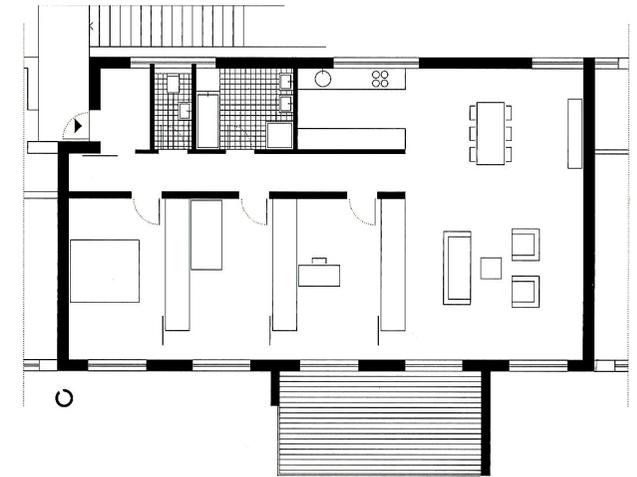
Nutzungsneutraler Grundriss von Baumschlager Eberle, Nüziders 1996
